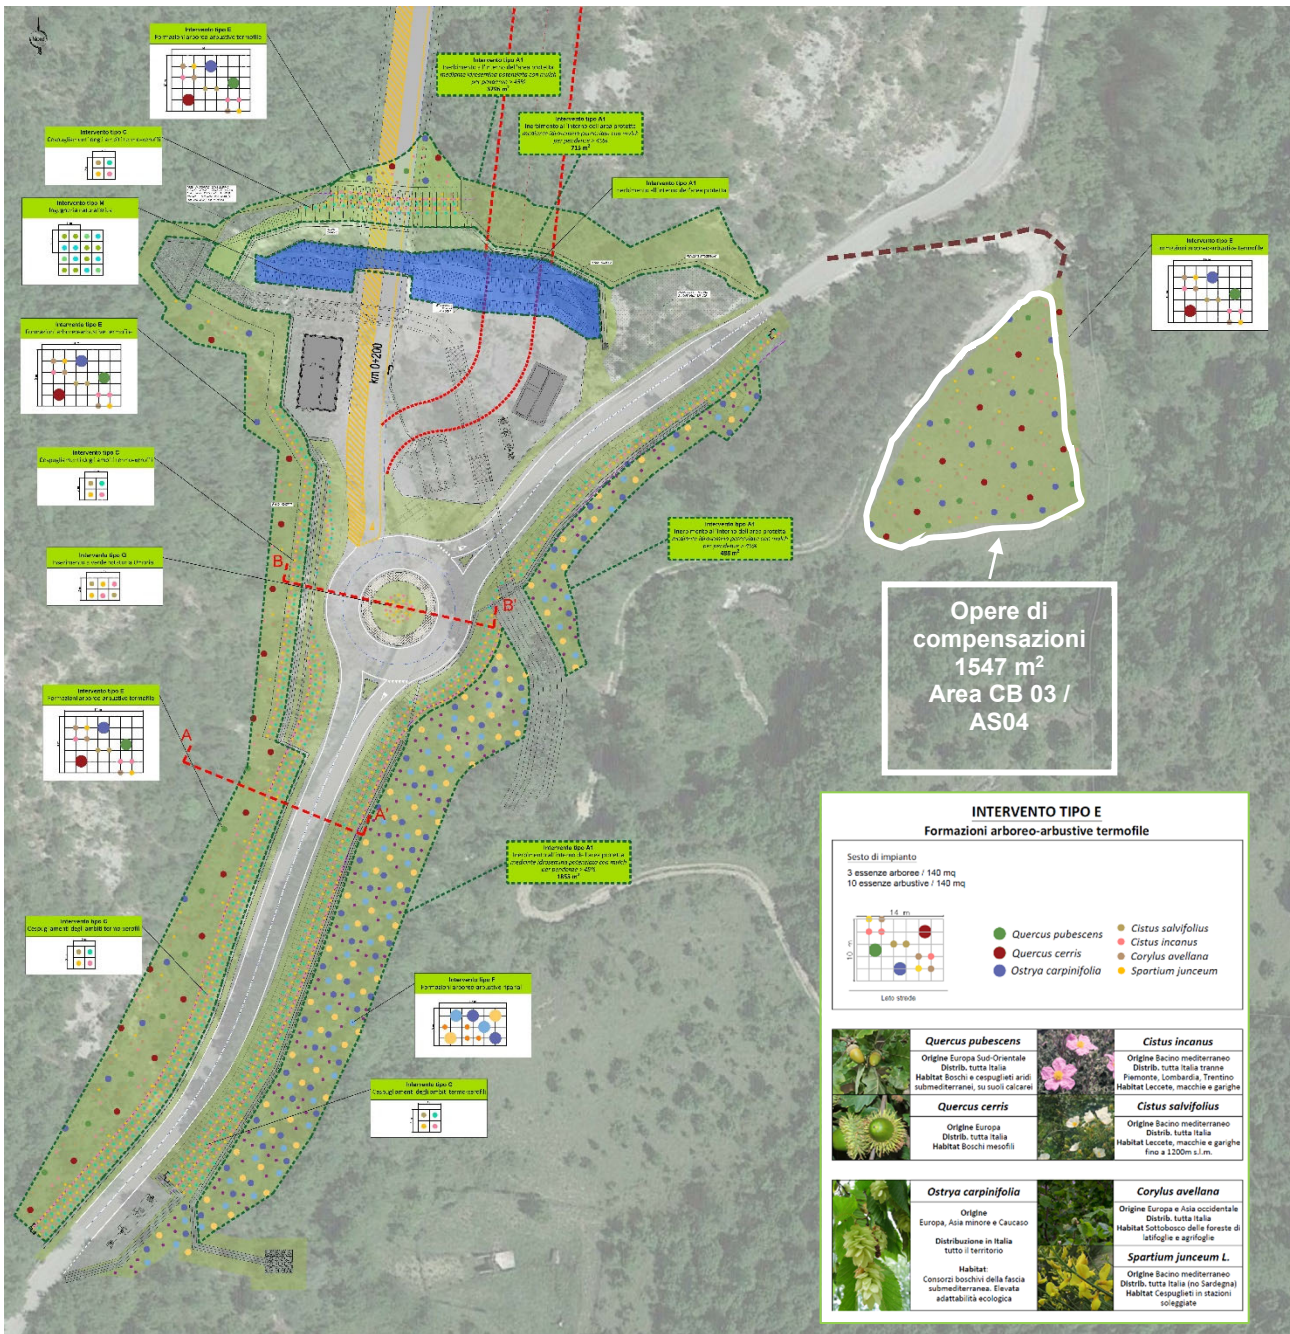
Localizzazione delle opere di compensazione forestale rispetto alla nuova infrastruttura di progetto (estratto tavole di progetto T00IA01AMBPP01)
